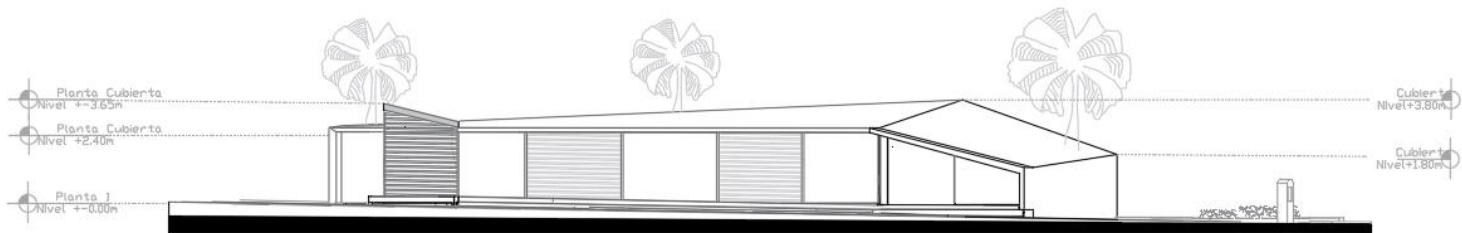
Fachada Oriente. (Fuente: Elaboración propia)
